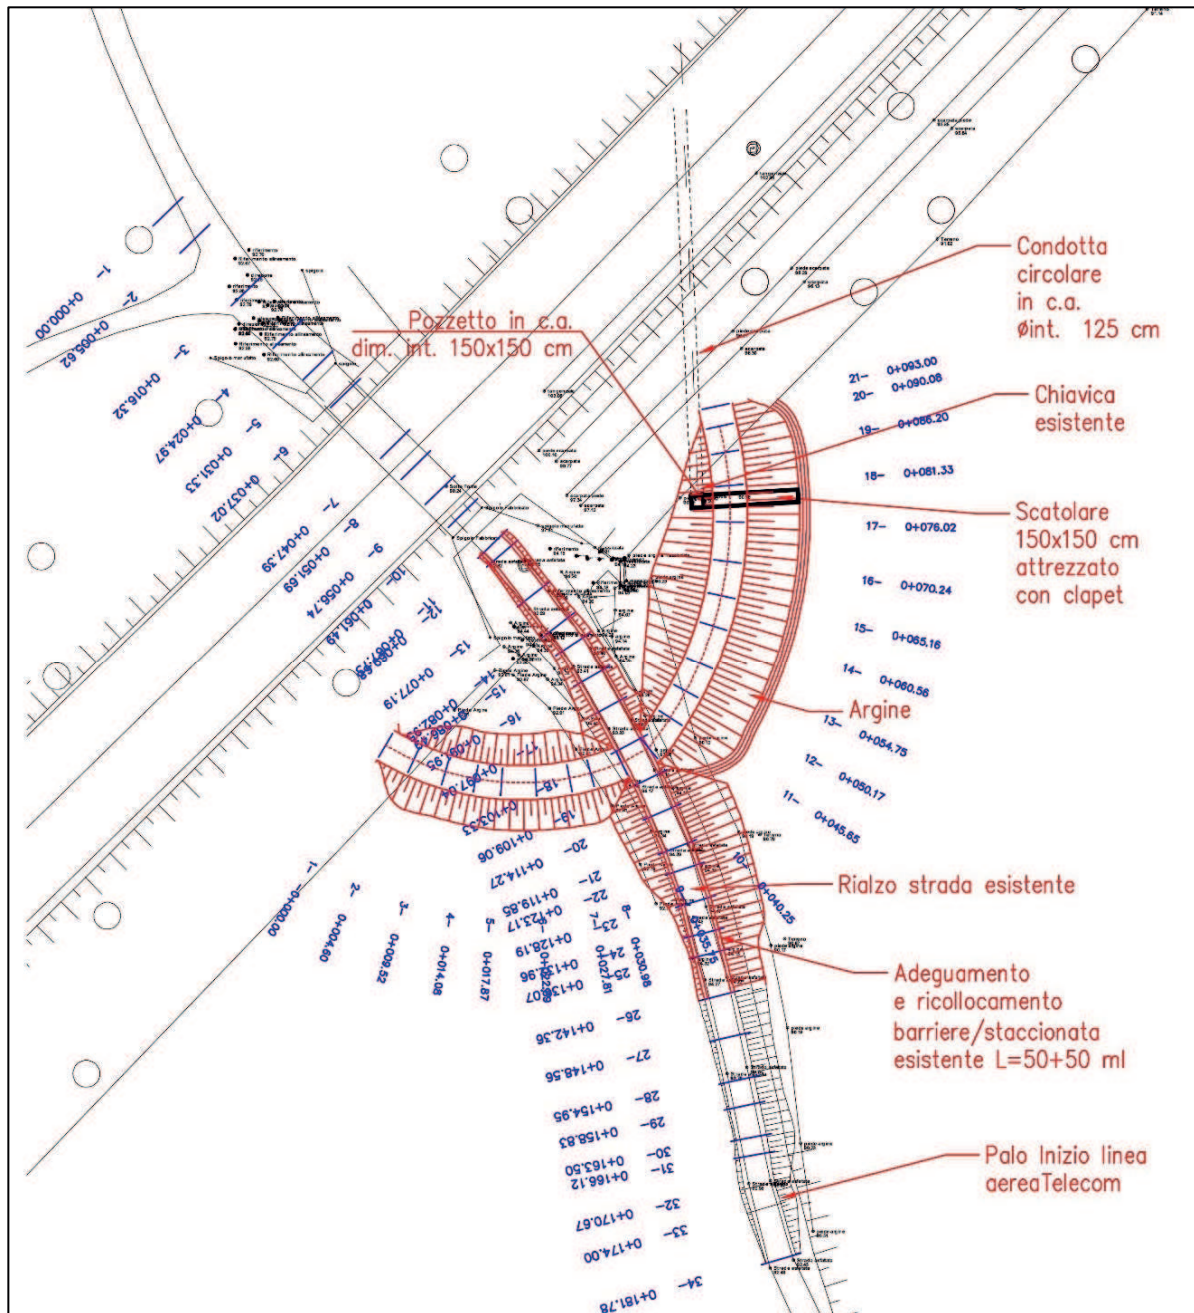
Arginatura chiusura fornice ramo sud Via del Chiozzetto – Planimetria
